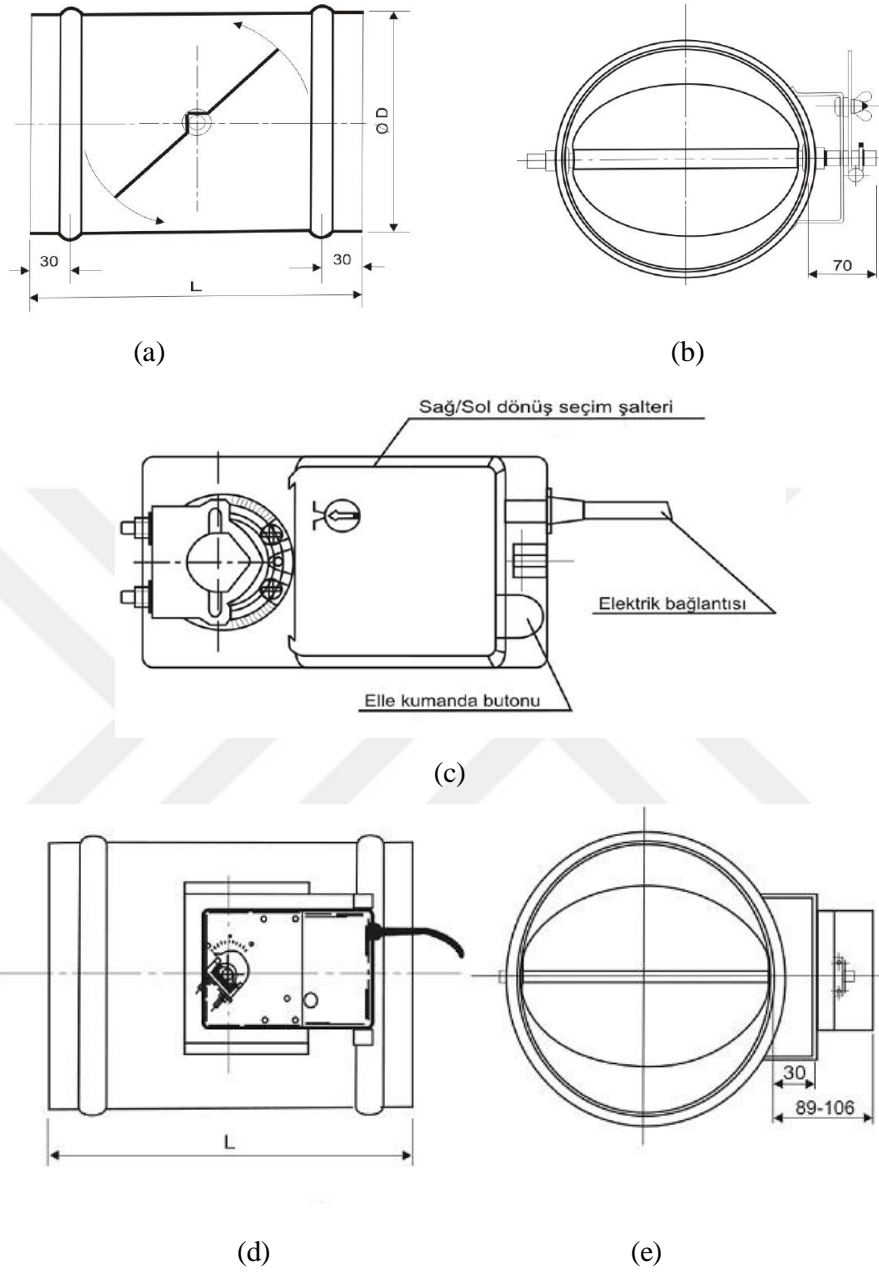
(a) ve (b) Adım motoru boyutları
